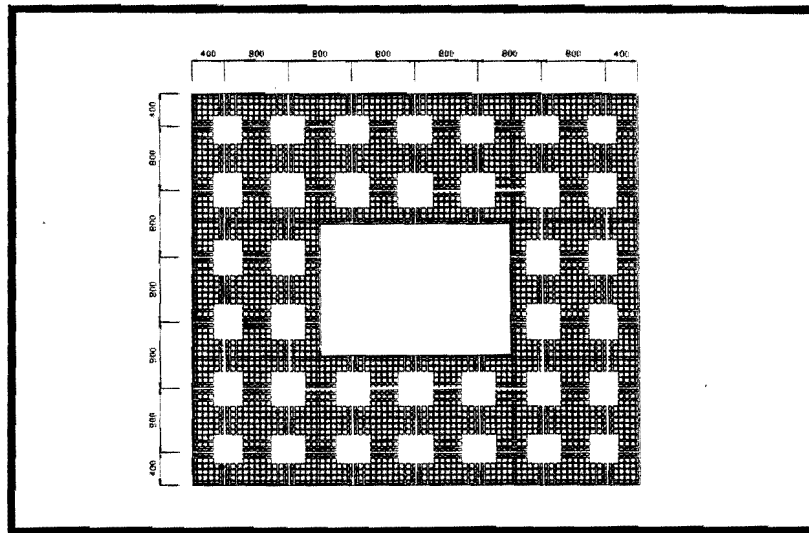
Vista inferior del refuerzo del ábaco en losa reticular.
